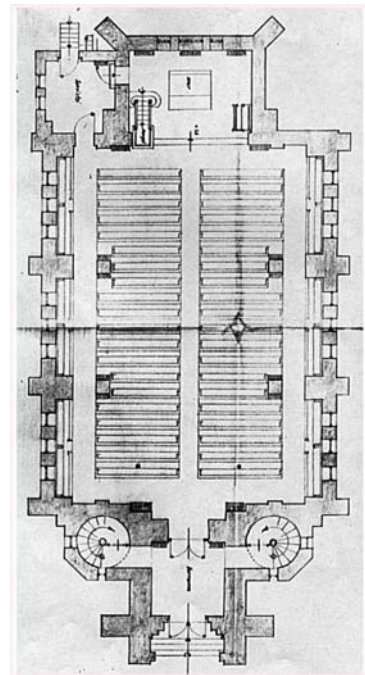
Grundriss, Bauaufnahme Oktober 1935
